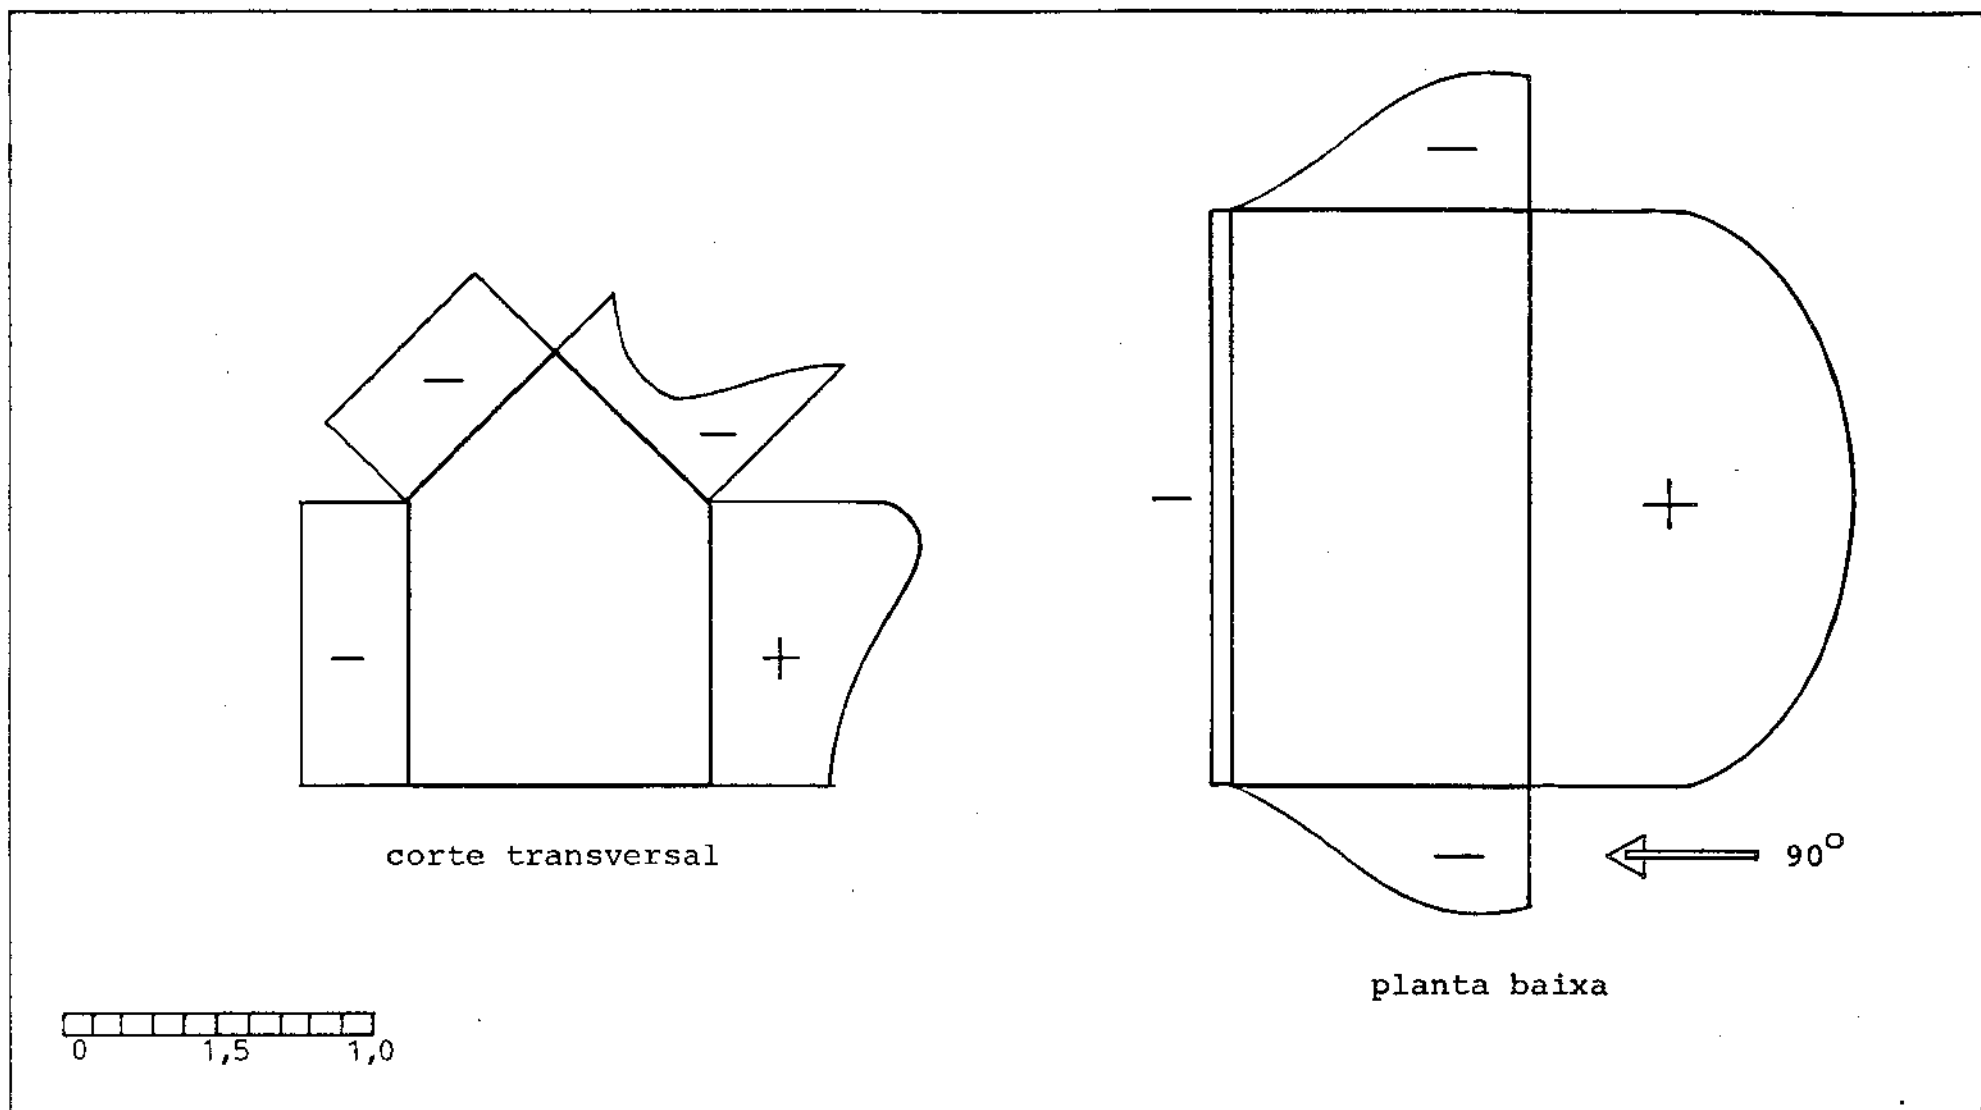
Distribuição de pressões para edificações de planta retangular, com telhado inclinado a 30° (Toledo, E., 1967) [68].
